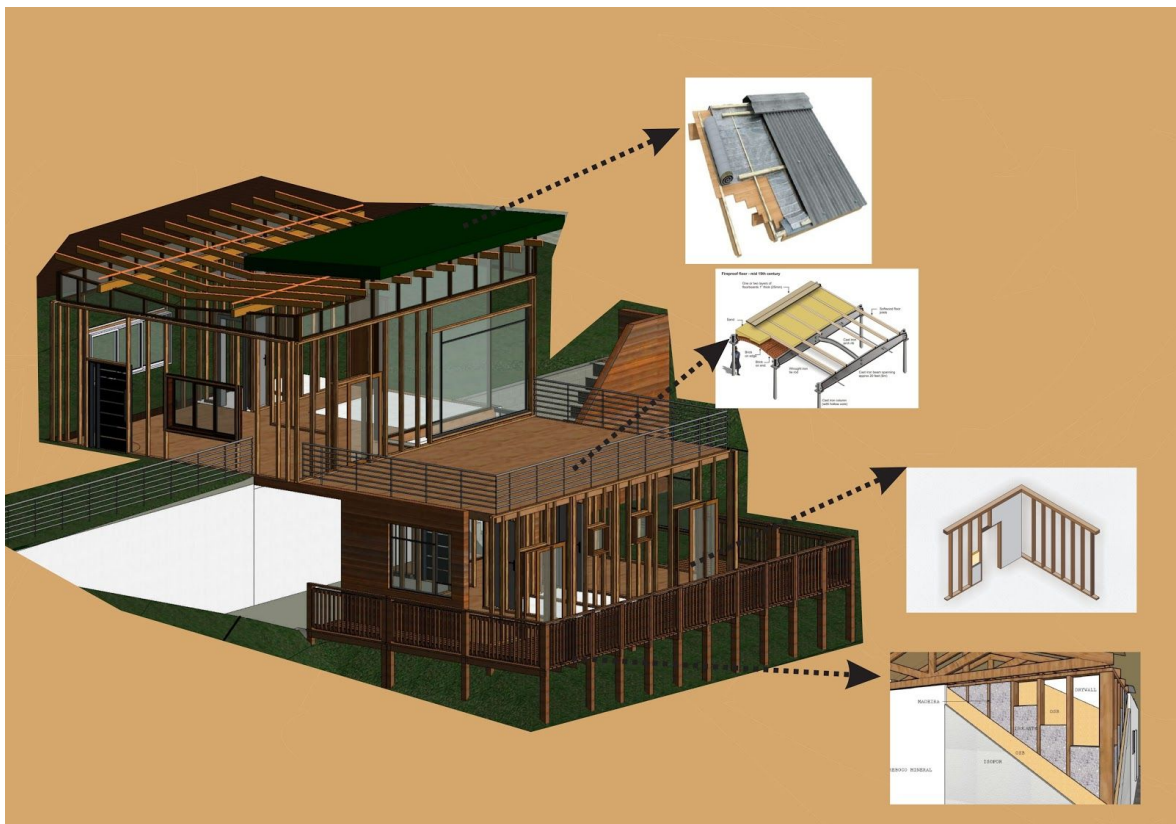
Detalhe do sobrado em sistema Wood frame no ambiente virtual 3D do Revit® . Fonte:
